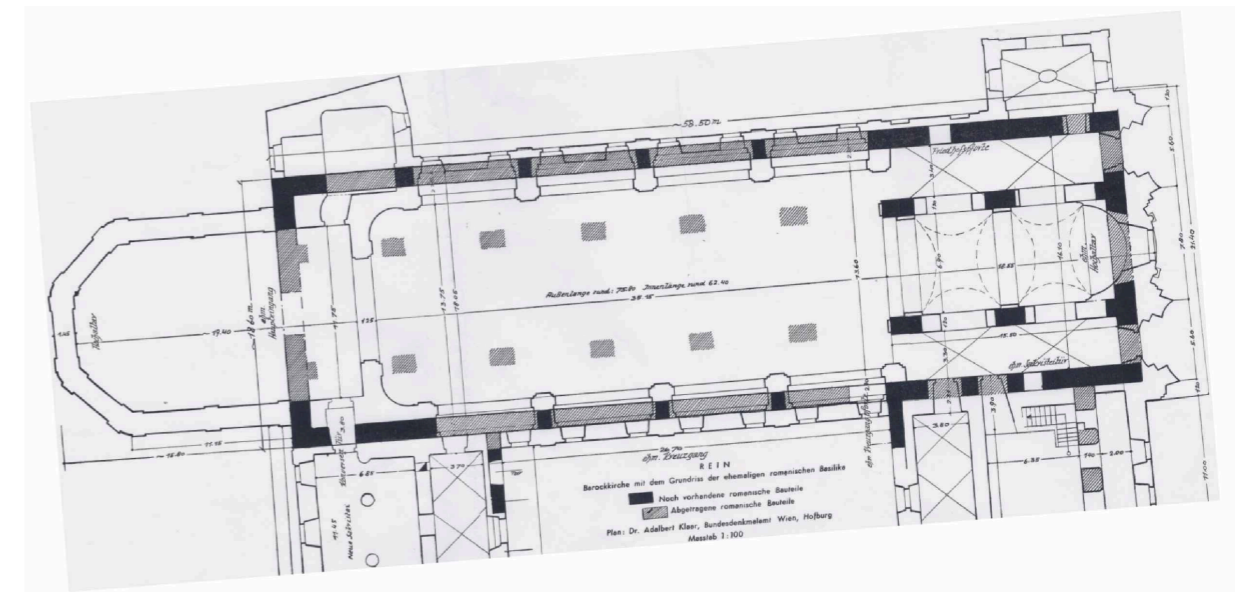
Stift Rein, Baualterplan von Adalbert KLAAR (*Bundesdenkmalamt Wien*)
